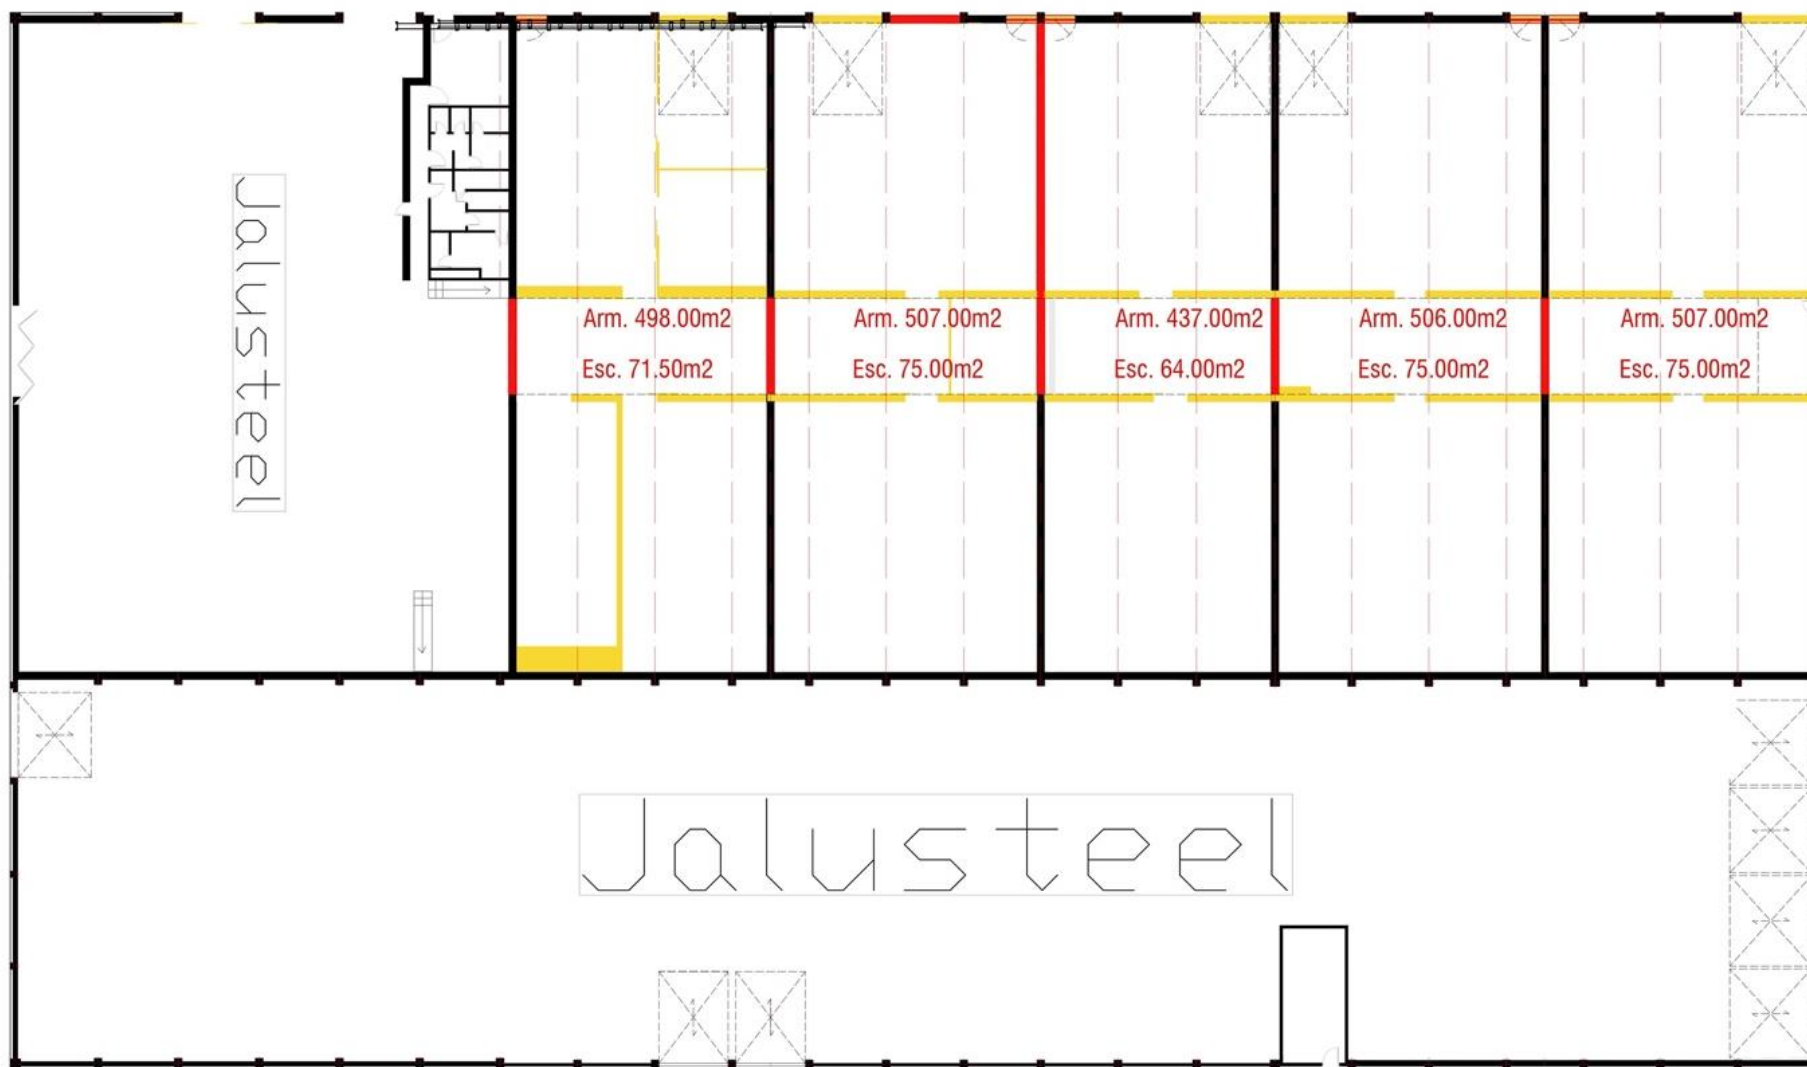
Corte em Planta das Novas Instalações da Jalusteel
